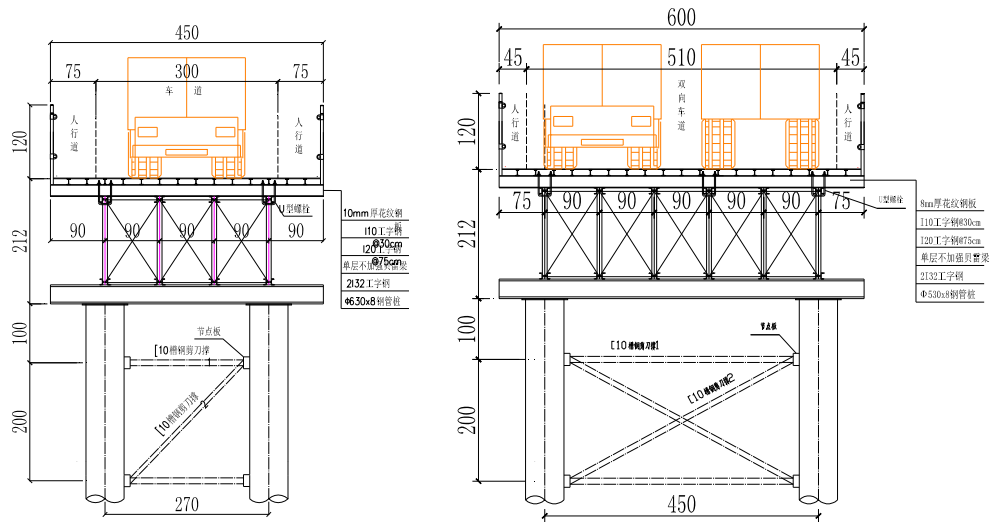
单车道栈桥参考示意图 (单位: cm) 图 3-4 双向车道栈桥参考示意图 (单位: cm)
